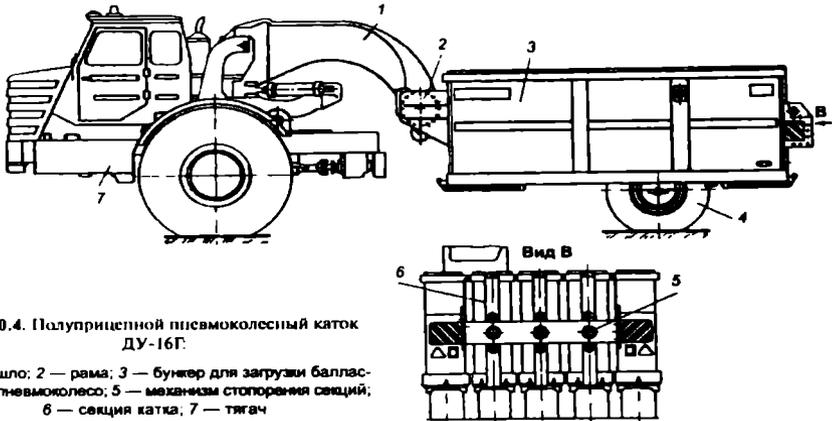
Полуприцепной пневмоколесный каток ДУ-16Г.
